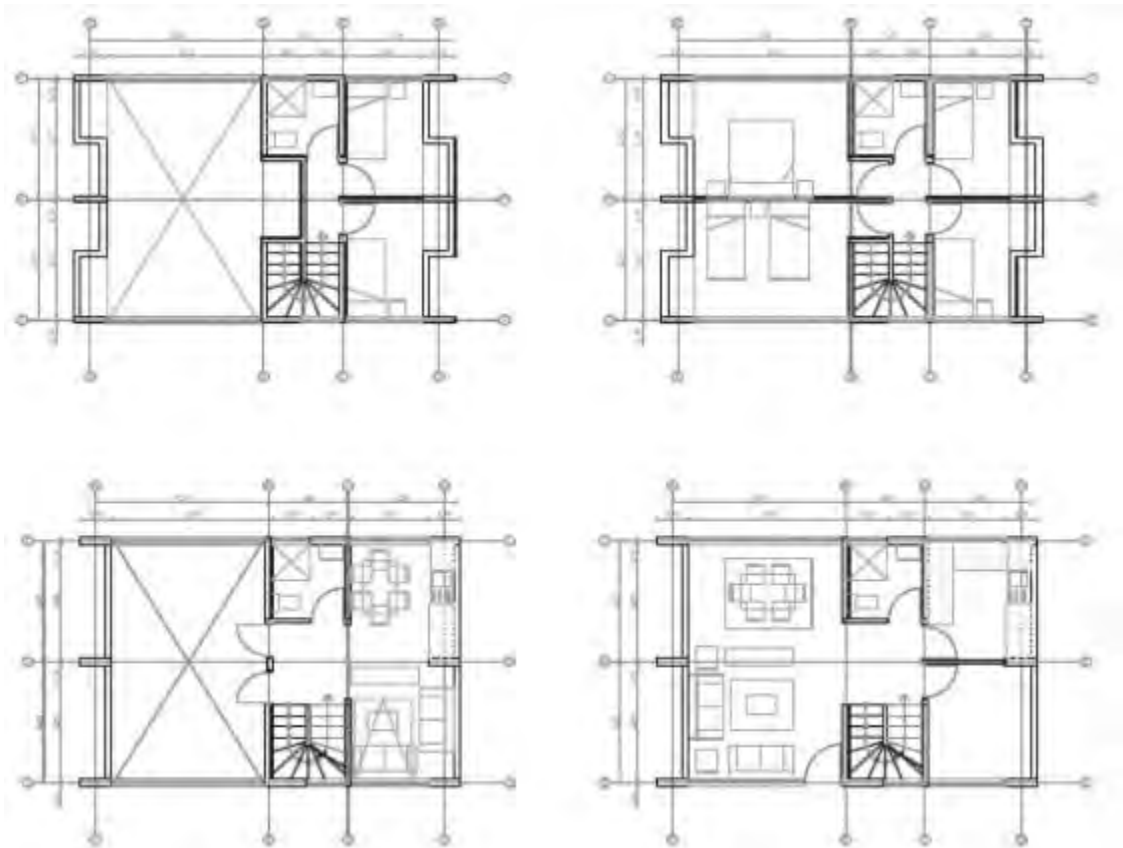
Diseño en planta de las viviendas antes y después de la ampliación (Gálves et. al, 2014)
